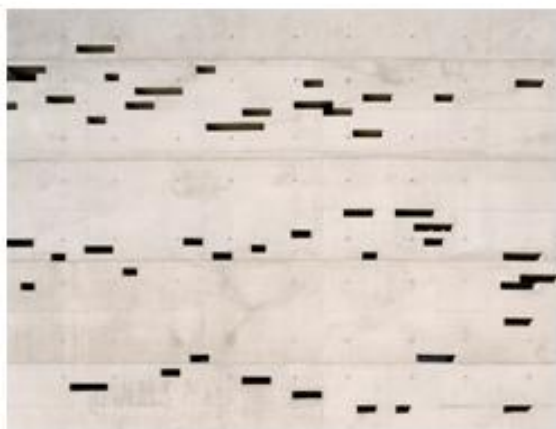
Pormenores dos negativos na fachada em betão à vista
